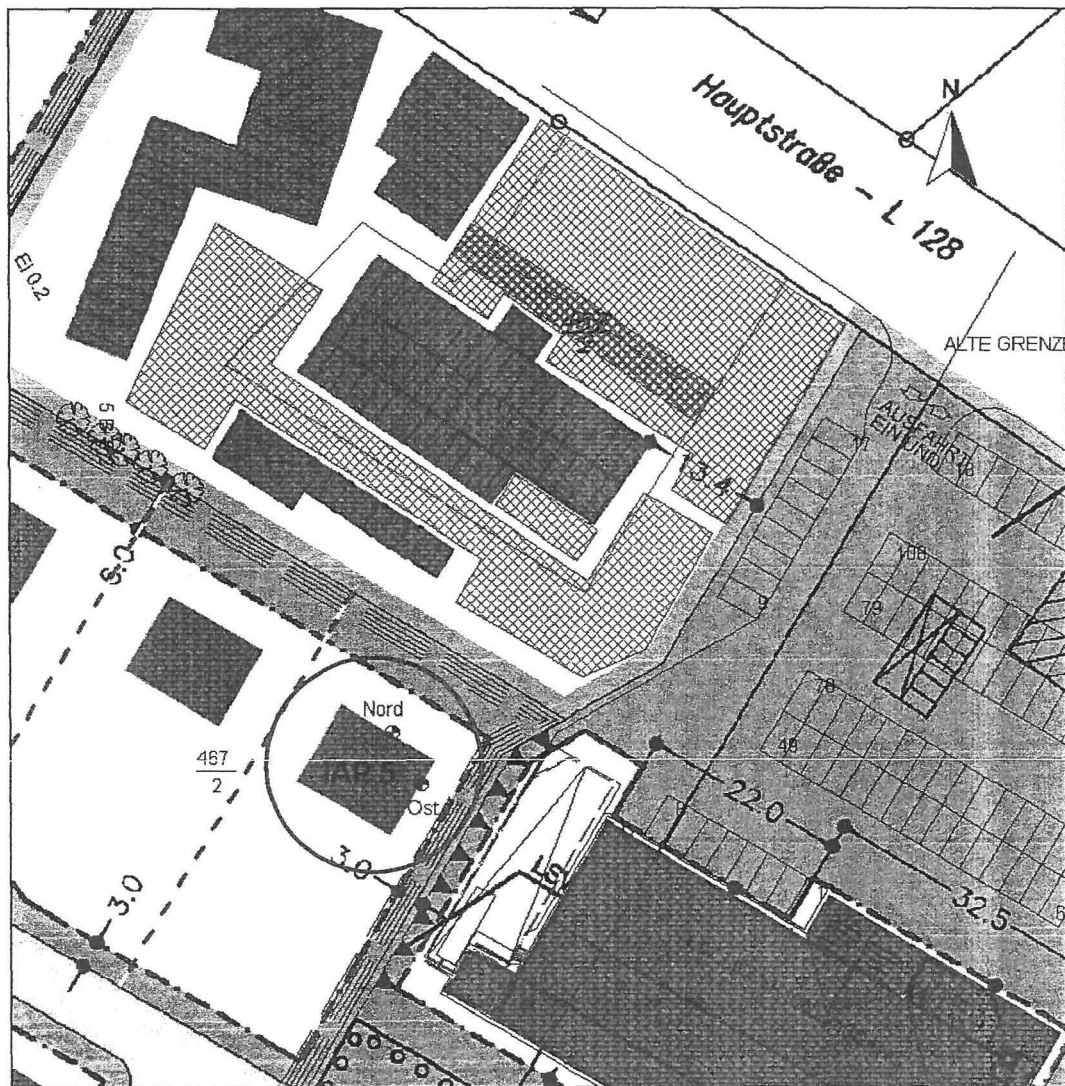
Lageplanauszug mit betrachteten Immissionsaufpunkten
